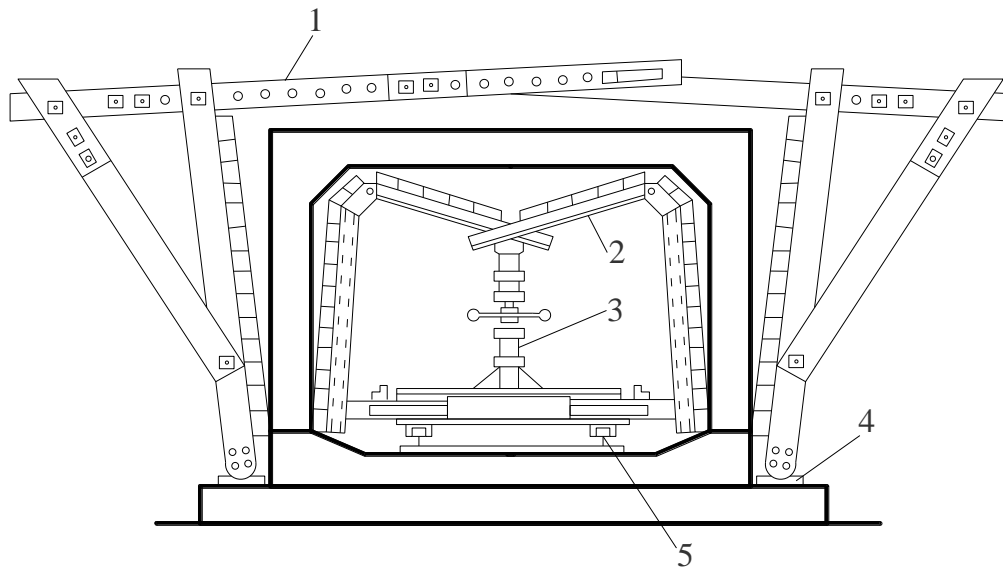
Котюча опалубка для бетонування прохідних каналів у процесі демонтажу:
